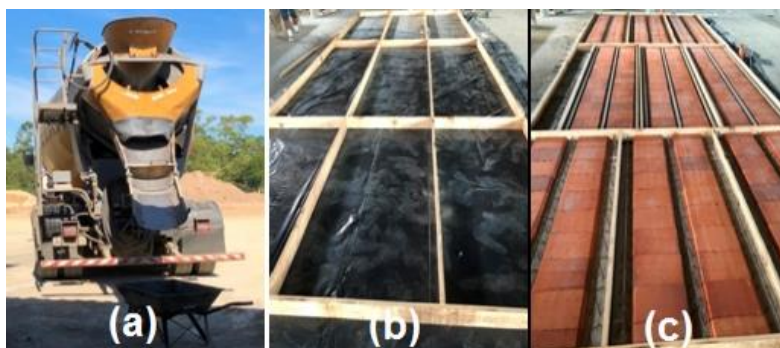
(a) Concreto usinado; (b) Formas de madeira; (c) Montagem das lajes treliças e lajes comuns.
